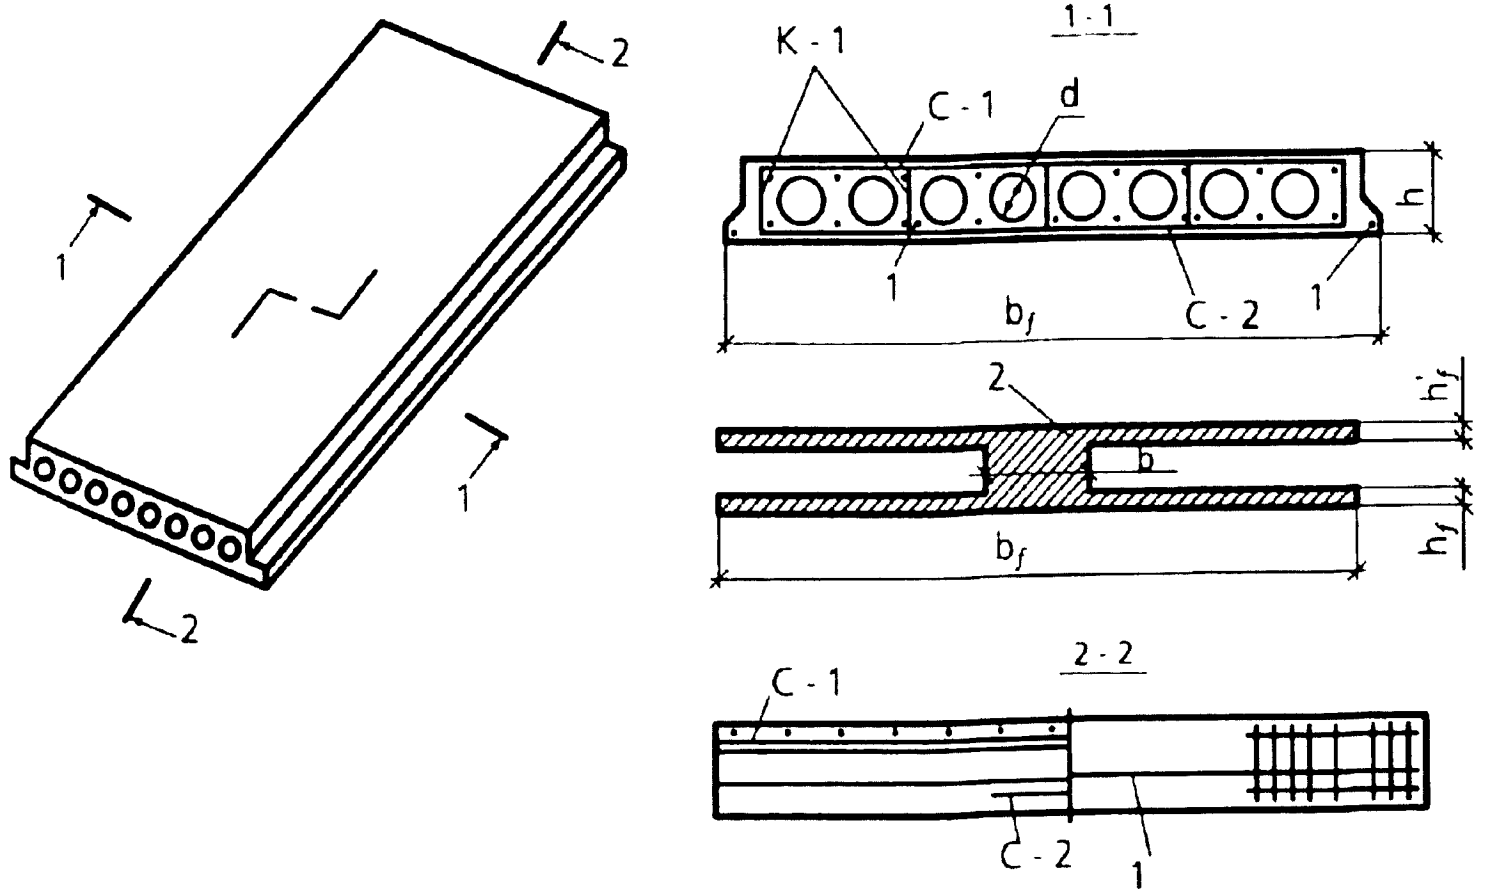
Конструкция сборной многопустотной панели перекрытия 1-напрягаемая арматура; 2-расчетное сечение
